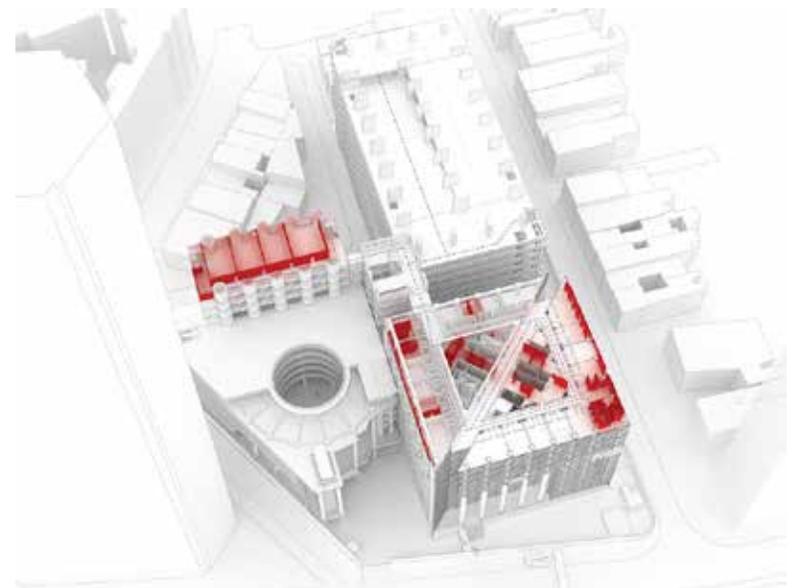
Grundriss des besetzten Gebäudekomplexes mit alten und neu-geschaffenen Zugängen
